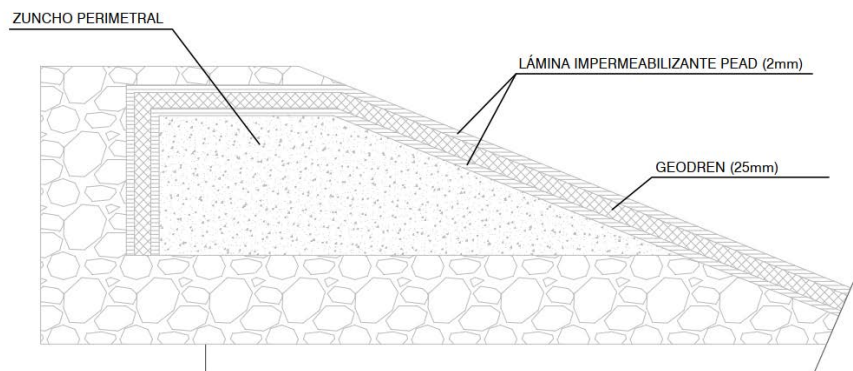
Detalle de la impermeabilización de la balsa y su anclaje
